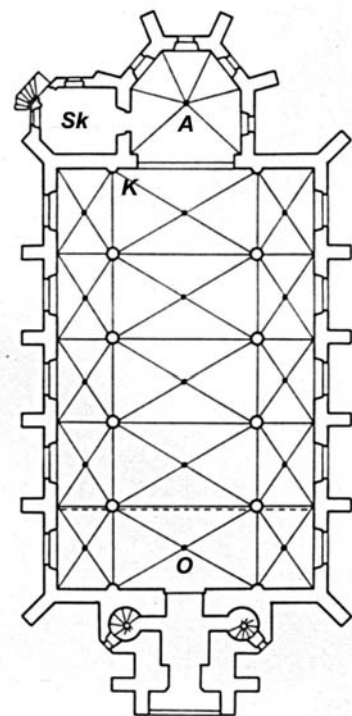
Grundriss, Anordnung der Prinzipalstücke
